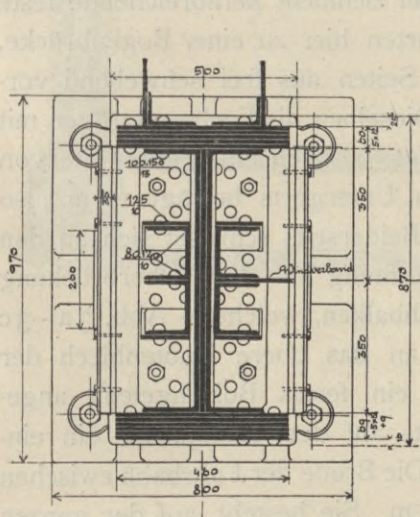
Horizontalschnitt durch den Bogen über dem Auflager.
